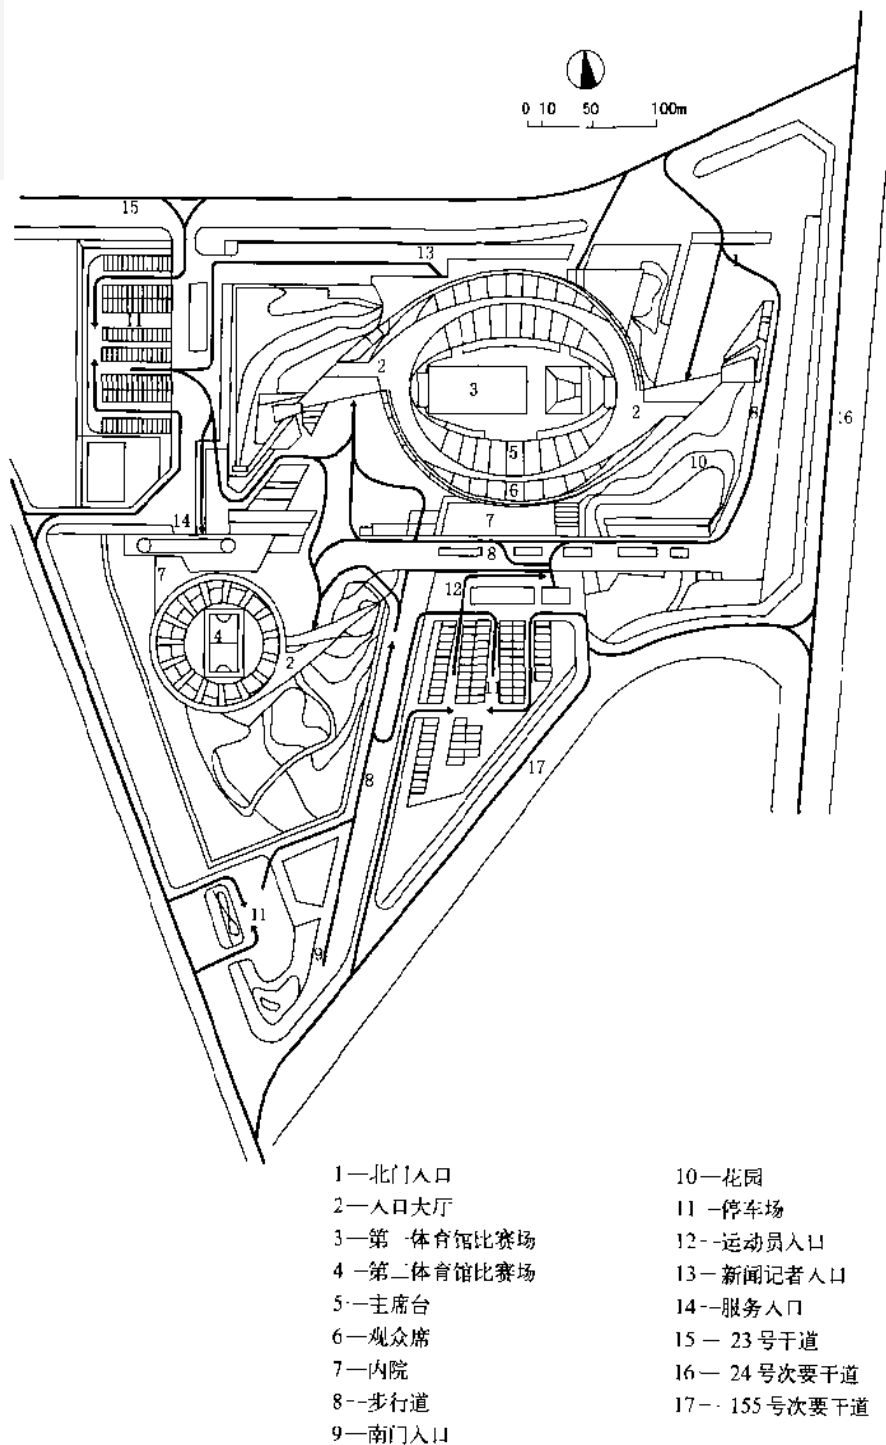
东京代代木国立室内综合体育馆总平面图
